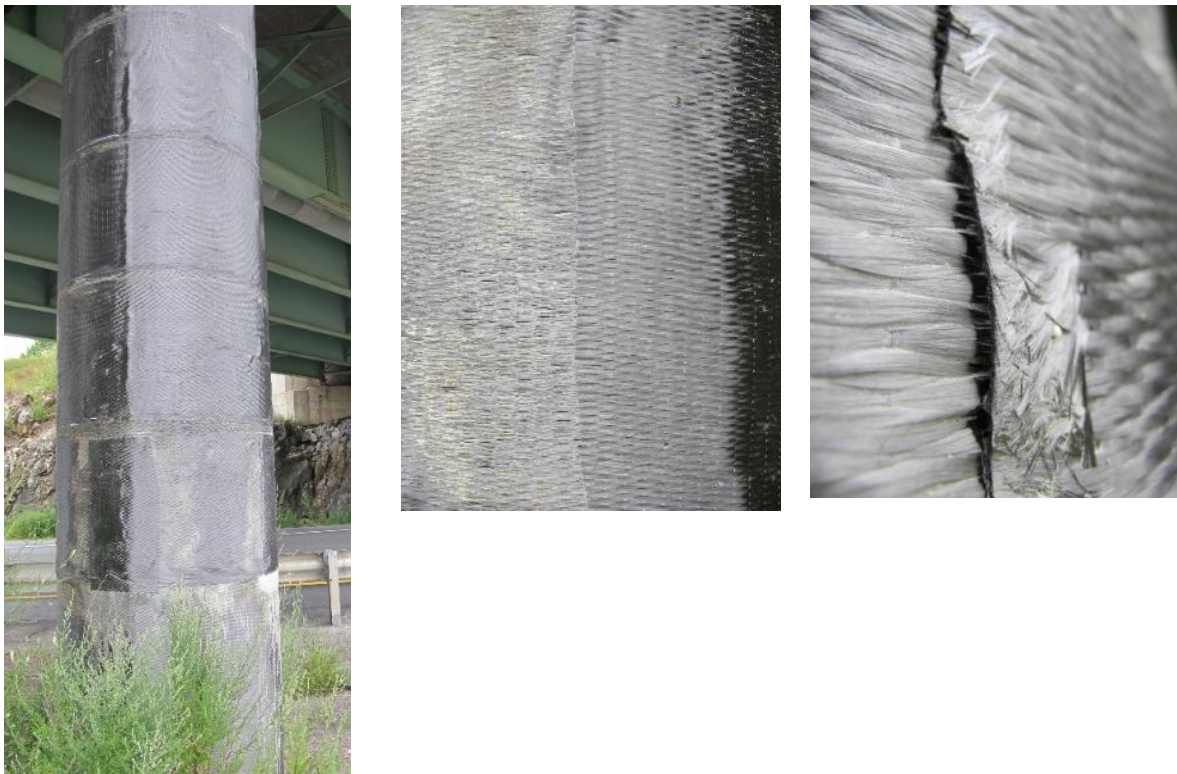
South Parkway bridge over I-395. Søyle nr 1-6 fra venstre, se Figur 42. (Foto: Eva Rodum)
